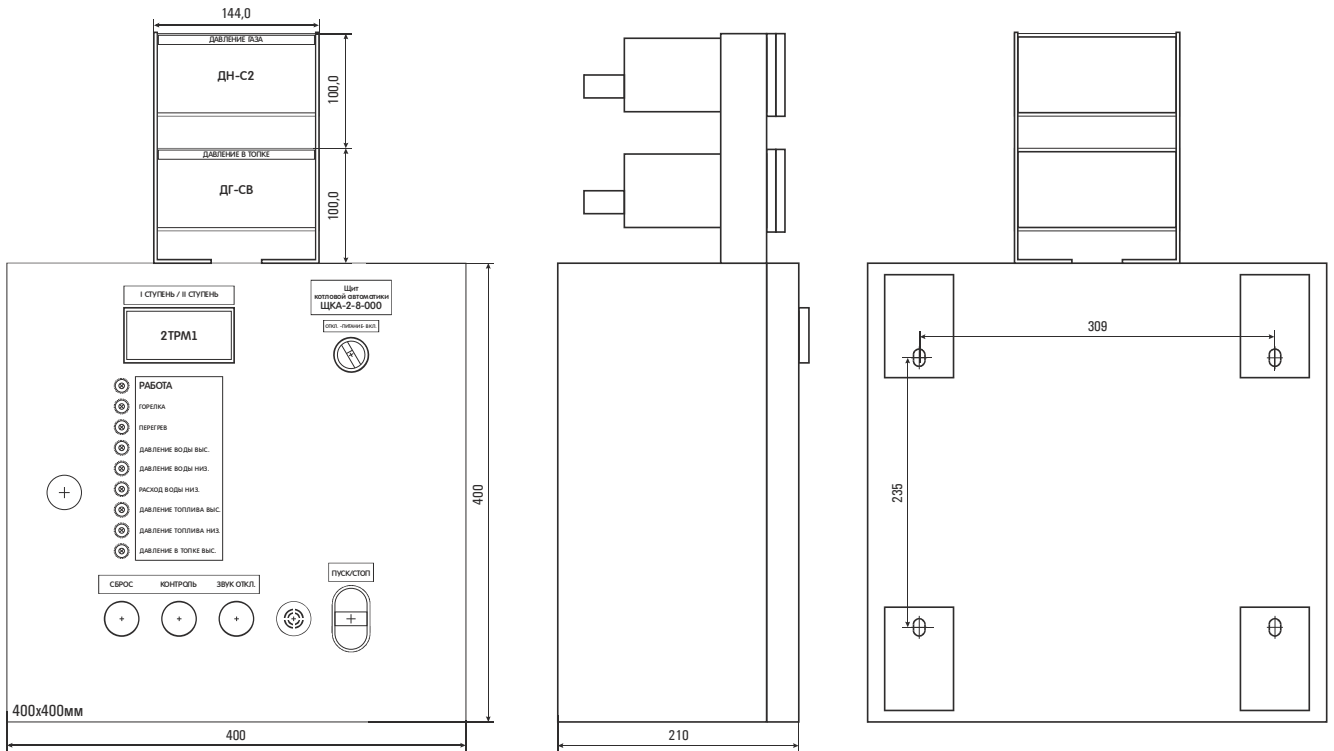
Внешний вид, габаритные и установочные размеры комплекта ЩКА-2-8-000/...-000К.
